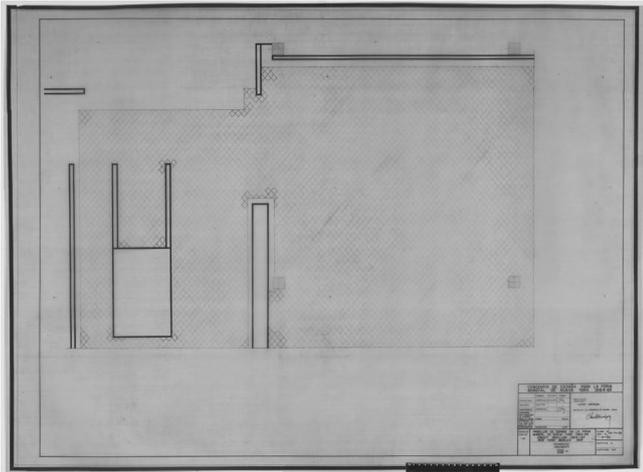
Pavimentos. Pavements. Zona / Zone 14. 63-74-93. A-56. Escala 1:25. Copia sobre papel vegetal. (AGUN).
